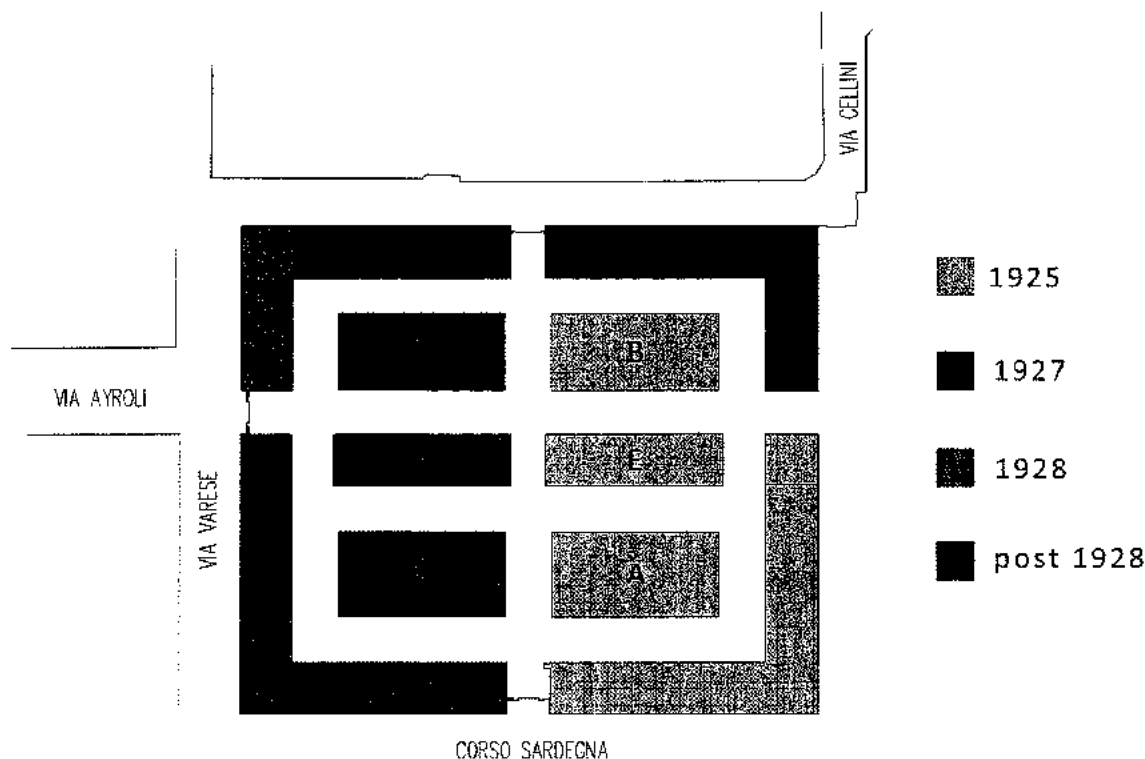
Planimetria del mercato suddivisa secondo le normative adottate
